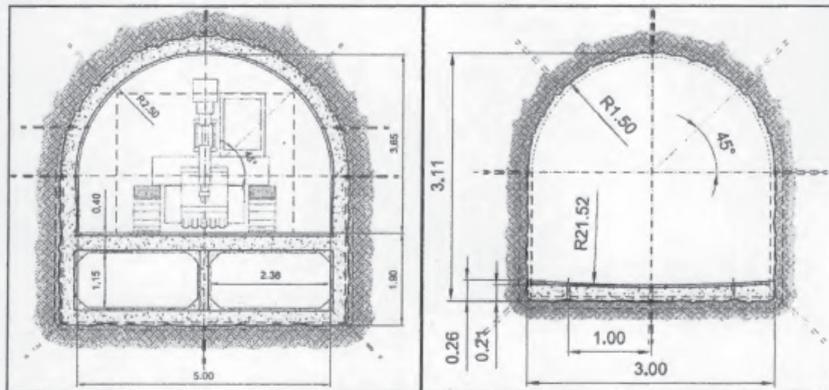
Izq.: Sección Tipo Tramo La Laguna a Vallecito – Der.: Sección Tipo Tramo Vallecito a Presa
